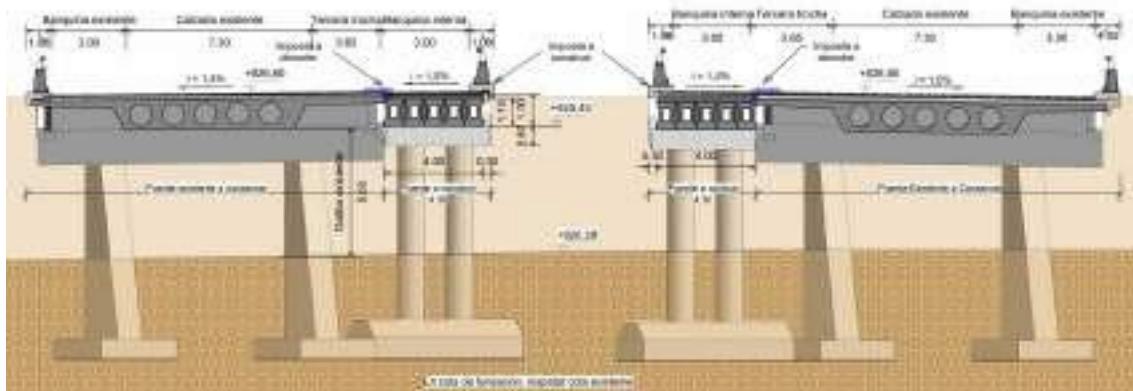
Sección Transversal Puente Anchorena - Obra nueva y obra a conservar
